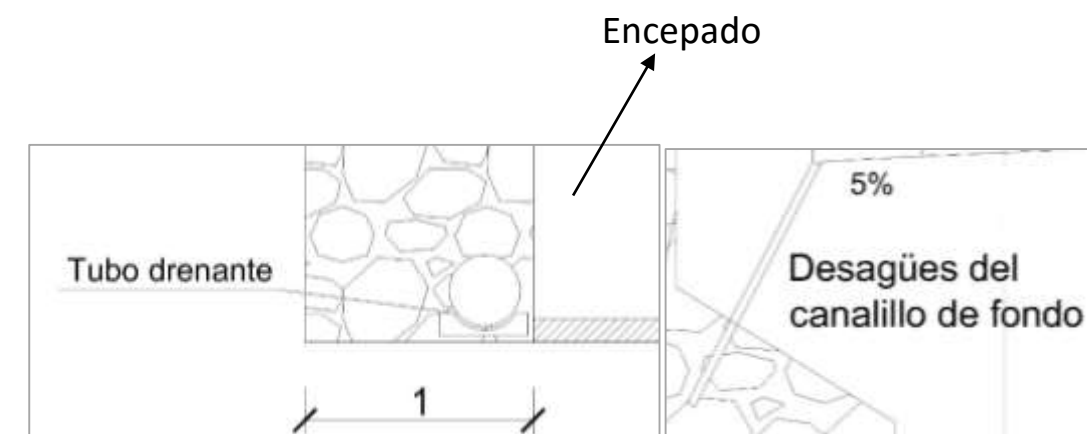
Detalle de tubo drenante y canalillo de fondo de ambos estribos. Fuente: Elaboración propia sobre alzado de estribo de AutoCAD.
